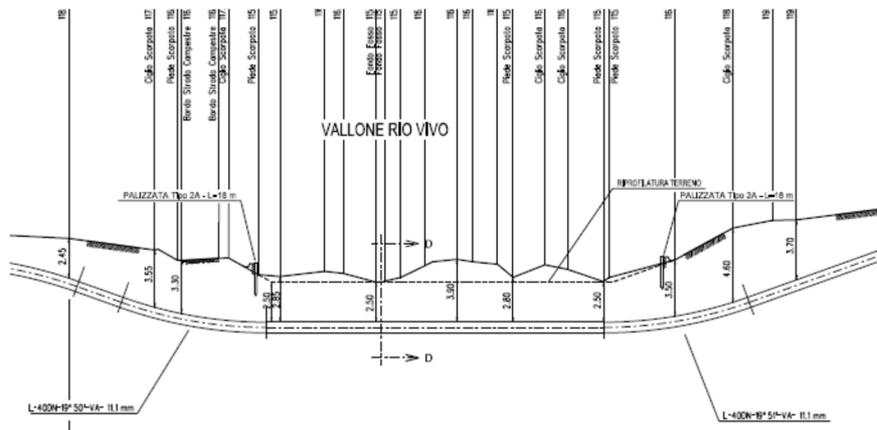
Attraversamento vallone Rio Vivo - ramo sx - Sezione schematica di progetto
